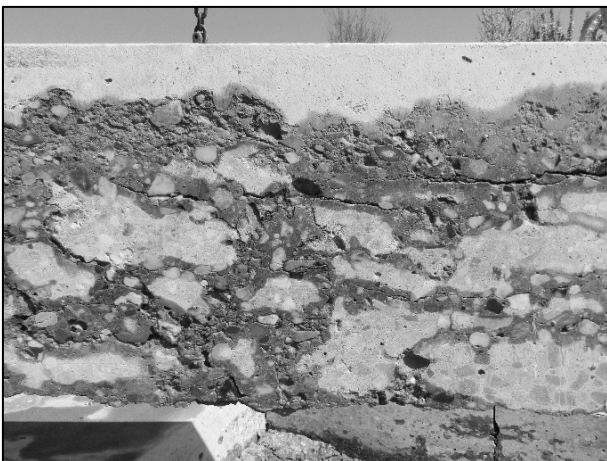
Freigelegter Fahrbahndeckenbeton im Fugenbereich mit Rissbildungen, die horizontal ausgerichtet sind
